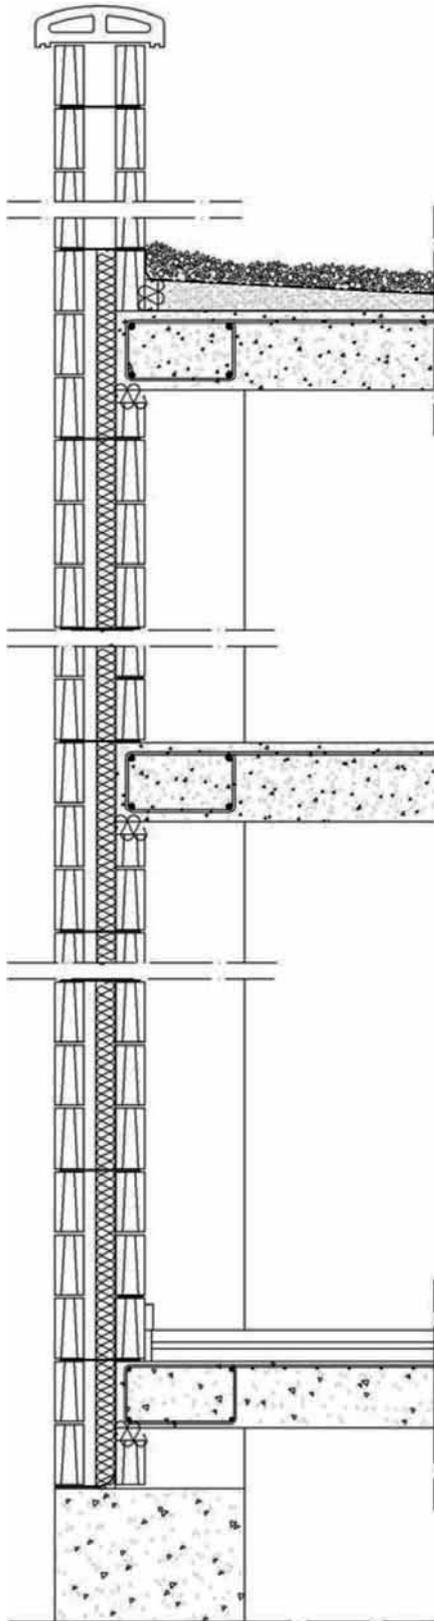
Sección de encuentro de muro de 2 hojas (DCW) de cerramiento y partición, a niveles de planta baja, intermedia y cubierta.
